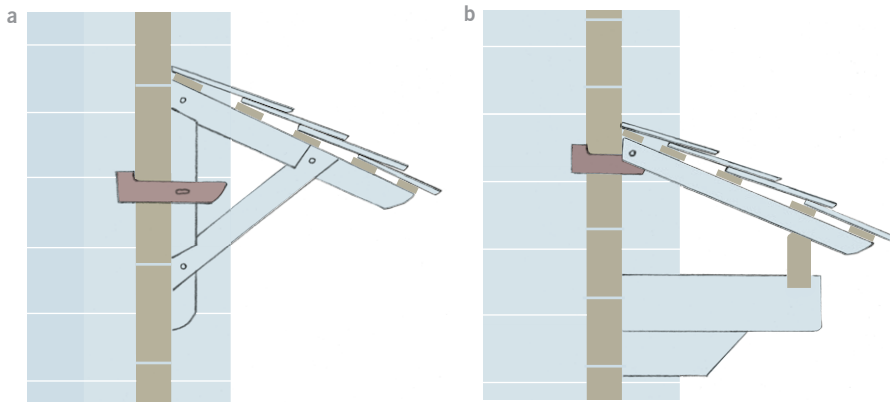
Mögliche Schutzdachkonstruktionen: a) Klebdach; b) Vordach.
